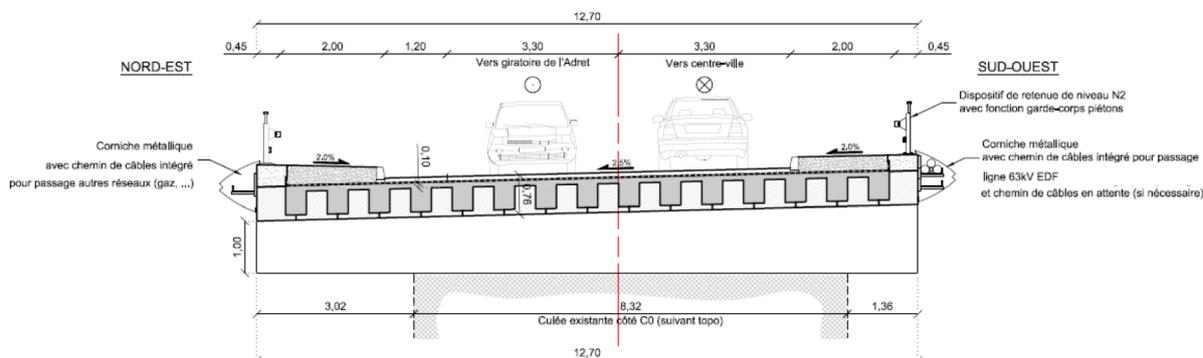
Exemple de pont en poutres inversés – Pont Adret – SCE 2021
